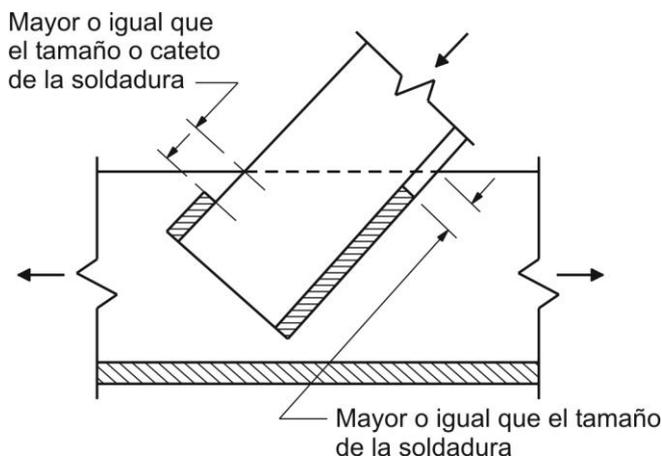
Terminaciones de las soldaduras próximas a los bordes de elementos estructurales sometidos a tracción.
